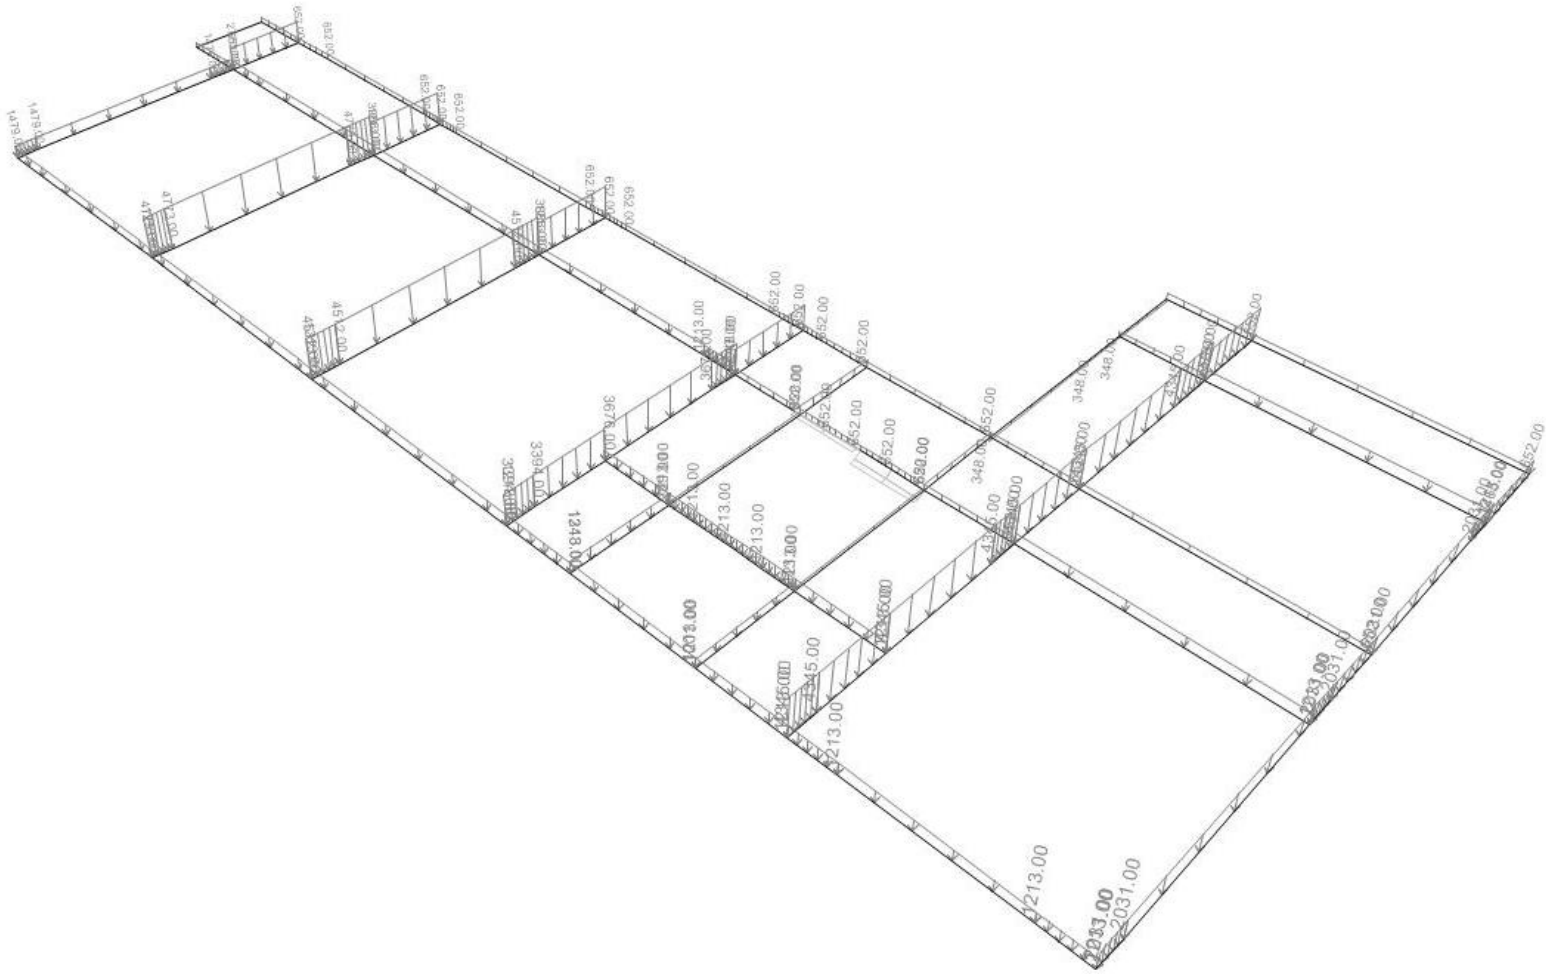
Carga viva sobre vigas de entrepiso N+3.00m y N+6.00m
